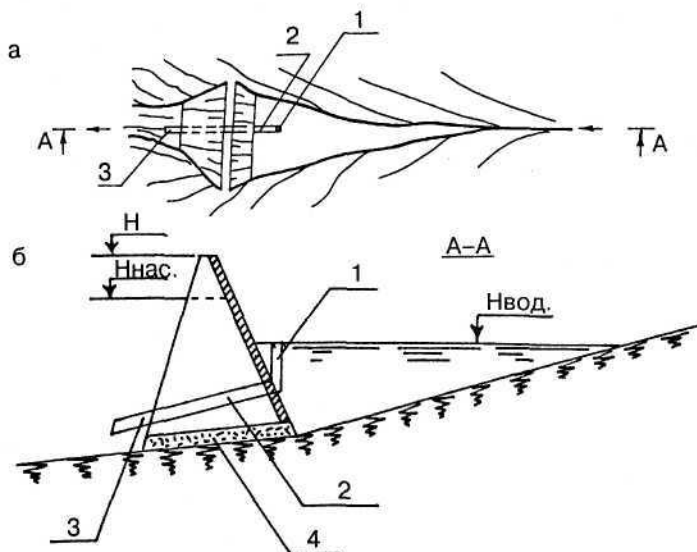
План (а) и схема (б) водохранилища с плотиной:
